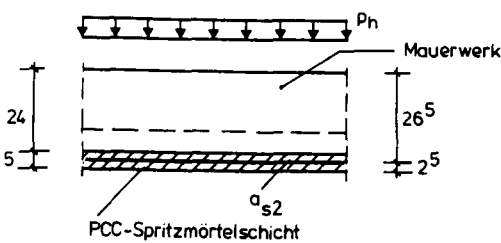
Horizontale Traglasten durch betonstahlbewehrte Ergänzungsschichten verstärkter, einseitig lastabtragender Mauerwerkswände: Variation der Mauerwerksdruckfestigkeit
